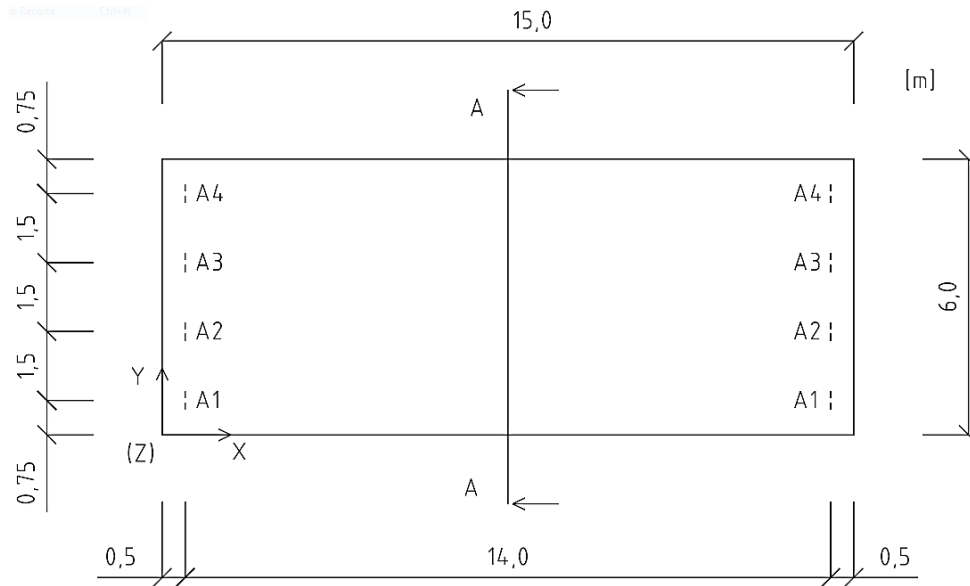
Planta da laje com identificação/numeração dos apoios pontuais
